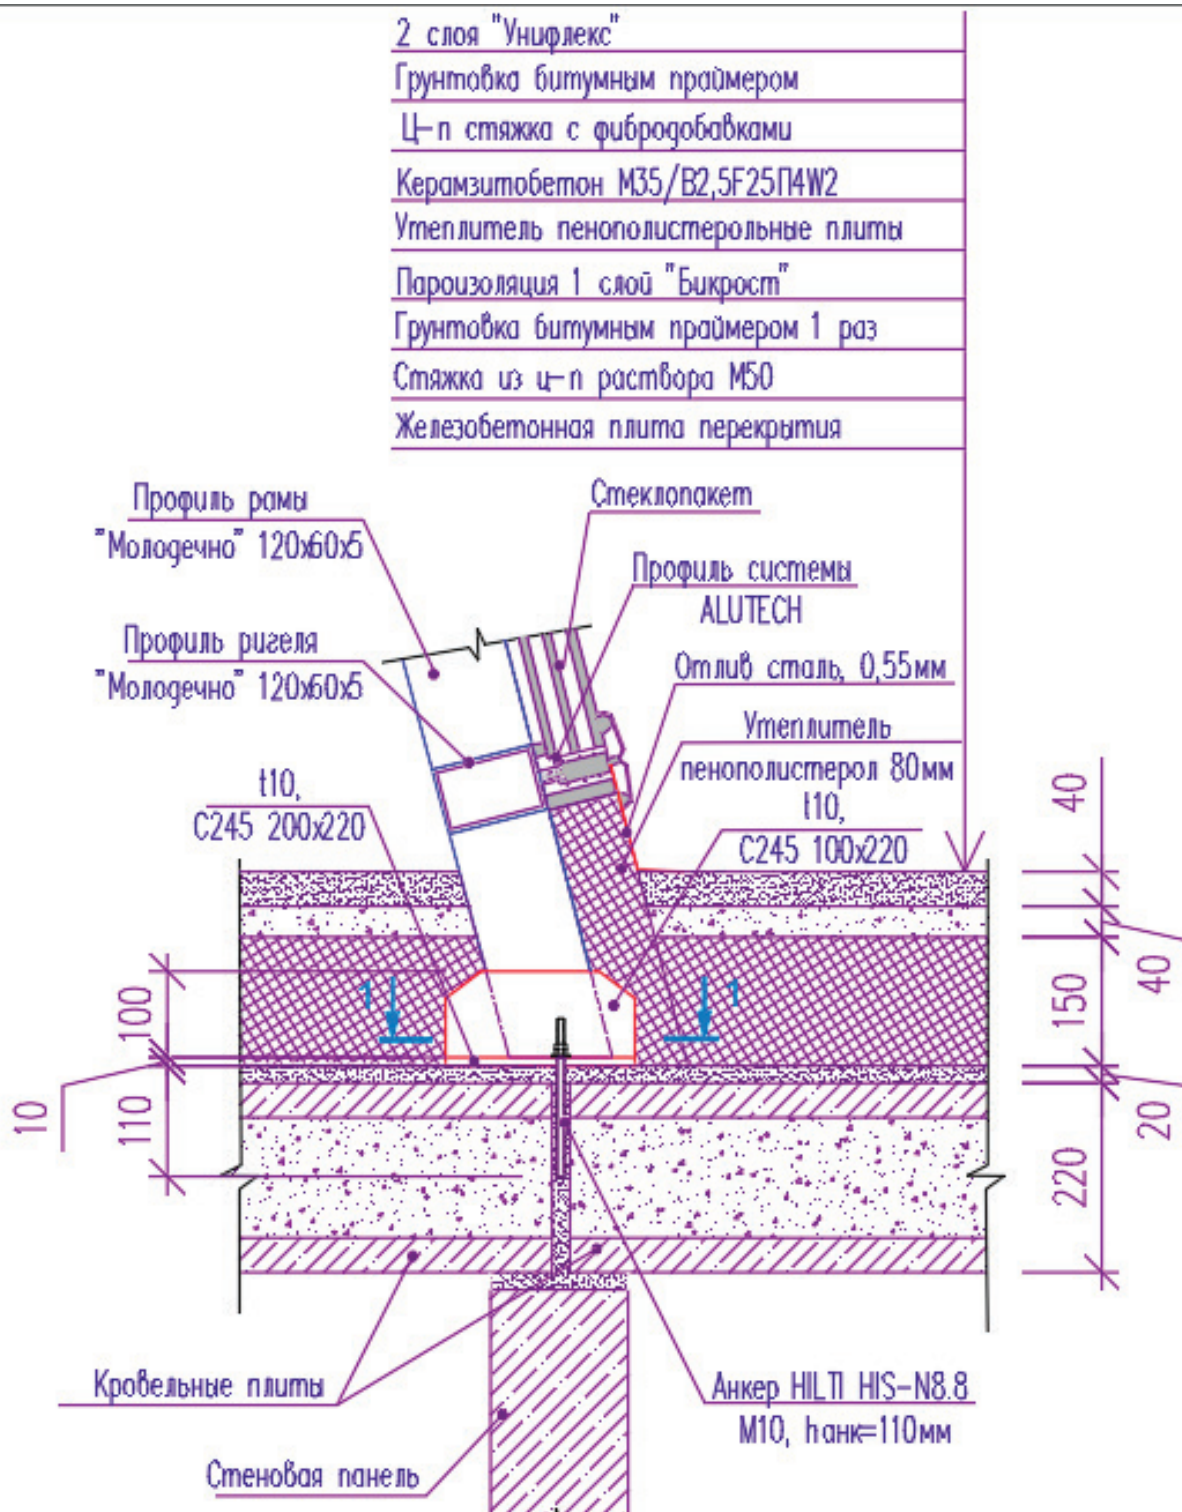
а. Узел анкерного крепления рамы светопрозрачной конструкции к плитам покрытия
